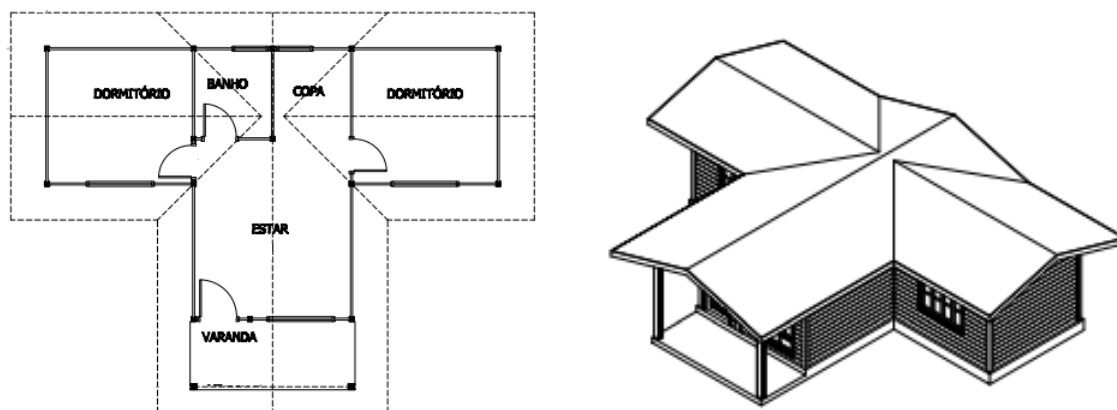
Exemplo da planta do T2, kit “Monet”, e sua perspectiva em 3D [22]
